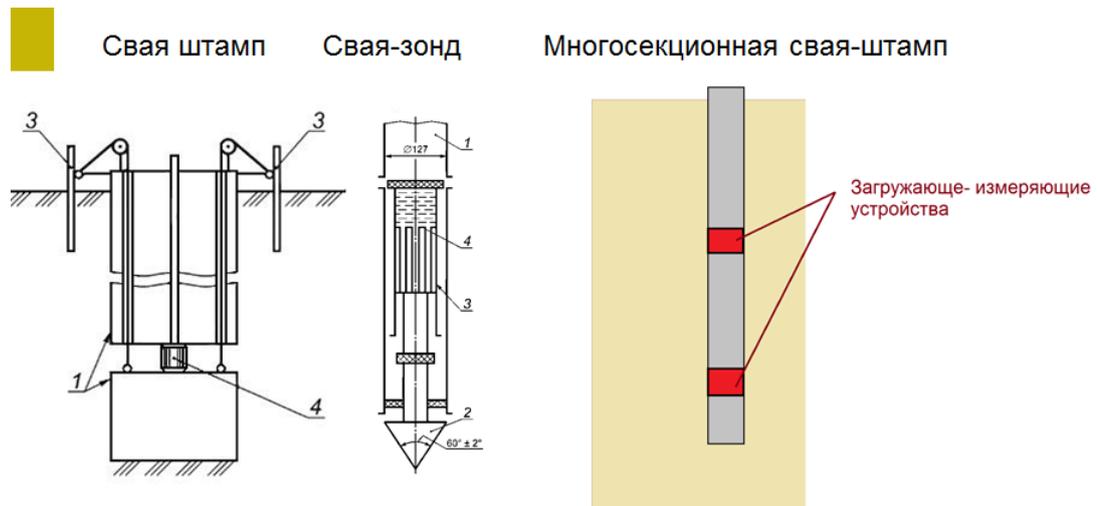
Схема испытаний а)- свай штампом; б)- свай зондом; в)- многосекционной свай штампом.
